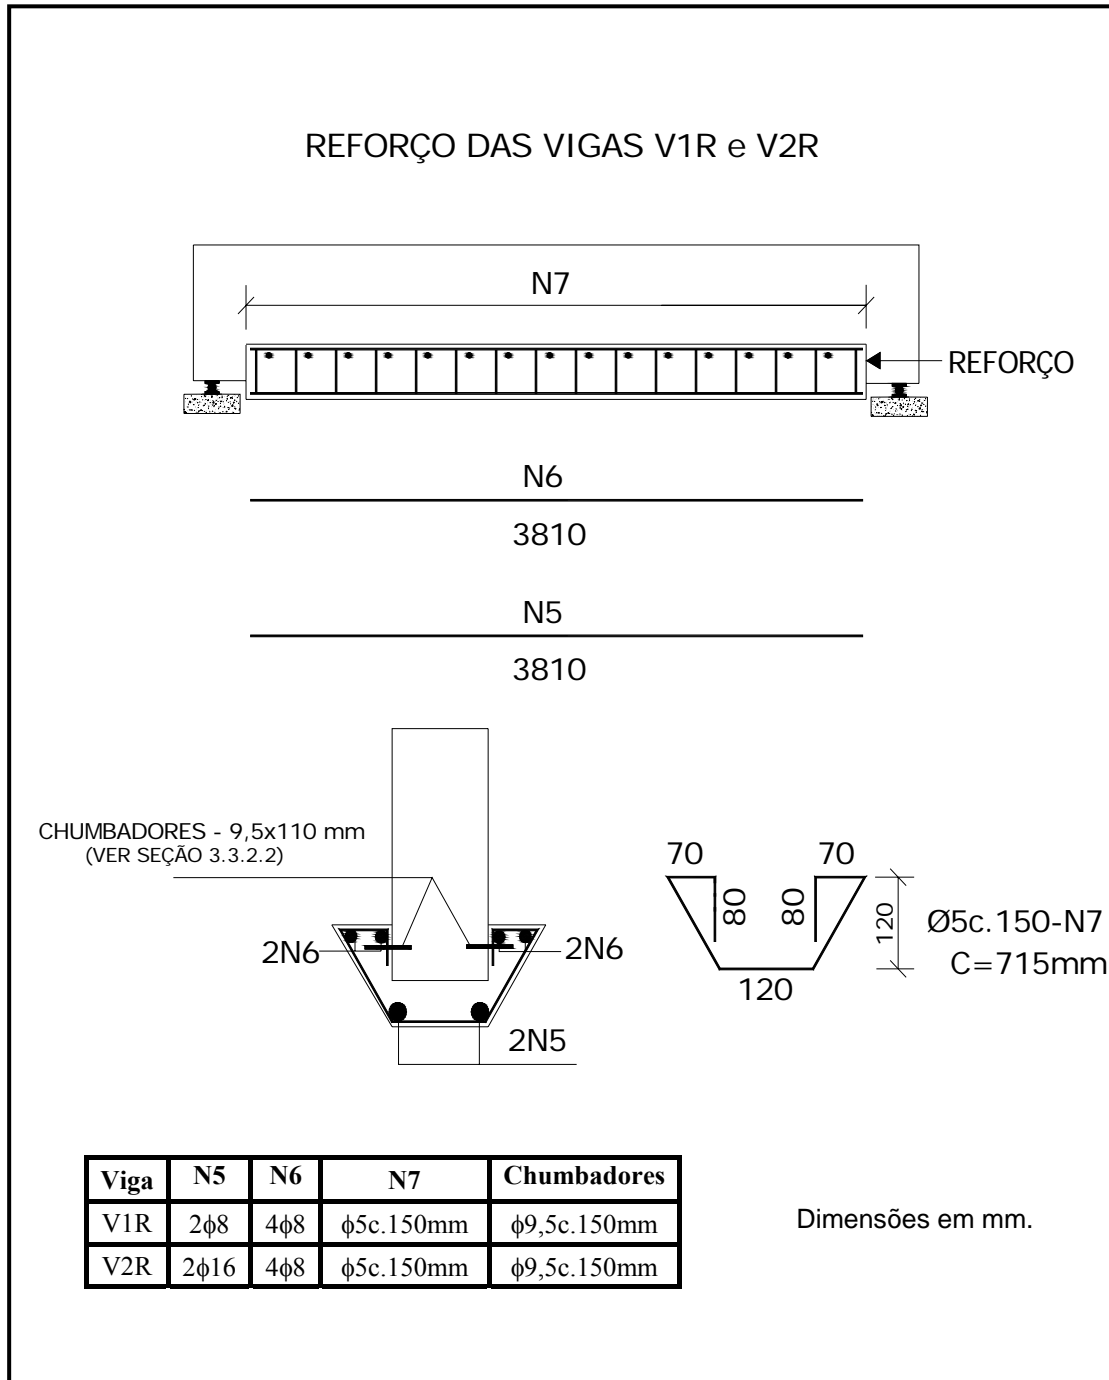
Detalhamento das armaduras longitudinais e transversais dos reforços.
